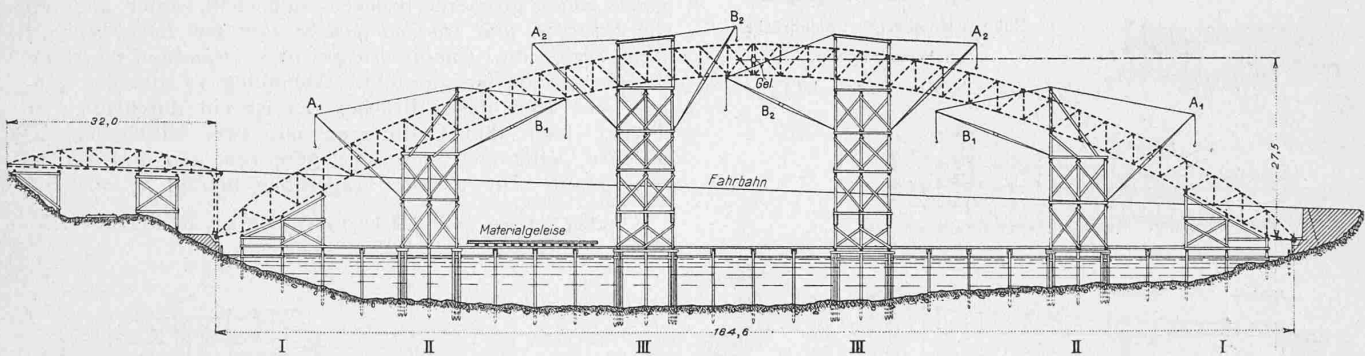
Montagevorgang der Strassenbrücke über den Connecticut bei Bellow-Falls, Nordamerika. — Masstab etwa 1 : 1000.
